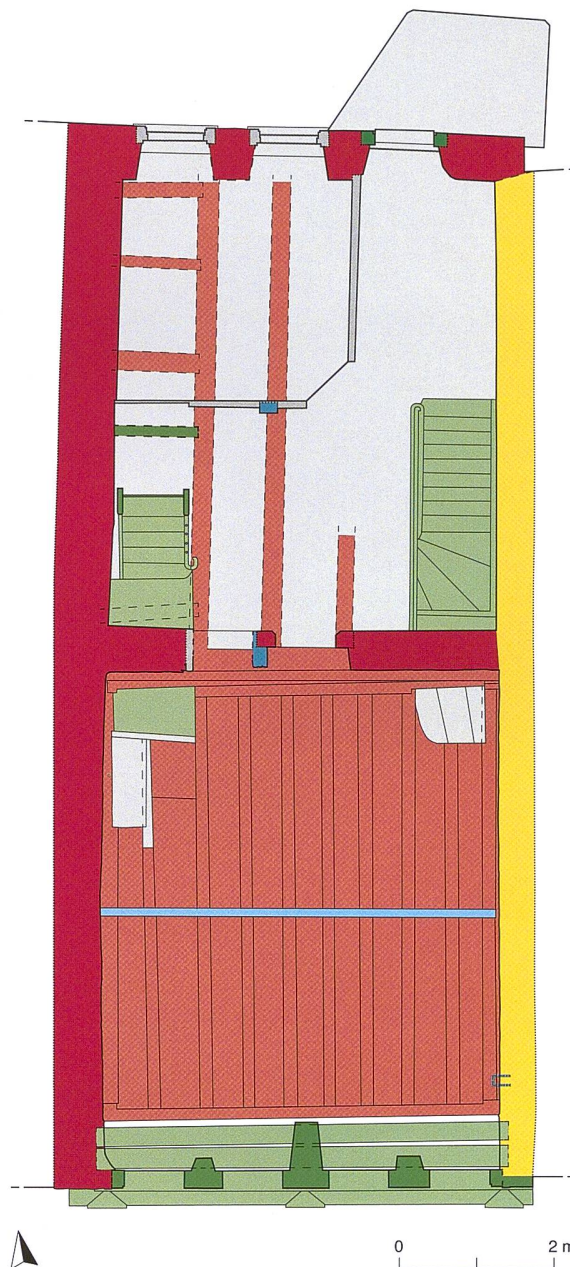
Rot: Bausubstanz des Gründungsbaus um 1523d. Gelb: Mauer des Nachbargebäudes Ägeristrasse 5 von 1499d. Blau: Erneuerungen und Einbauten des 17. Jahrhunderts. Grau: nicht datierte Bausubstanz und Bausubstanz des 20. Jahrhunderts.
